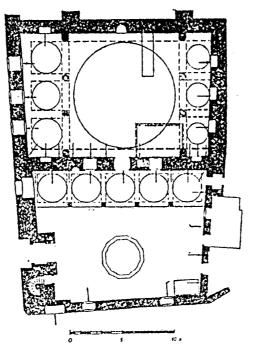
مسقط أفقي لجامع خسروباشا ضمن مجمعه بحلب (عن : جودوين).
